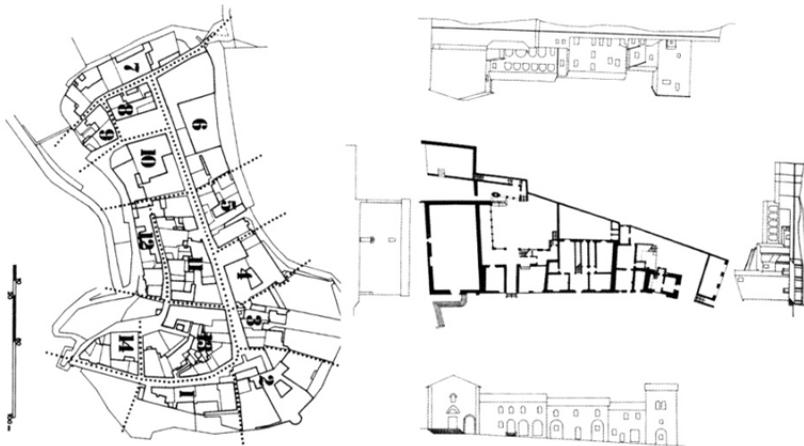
Rilievi dell'aggregato con pianta e prospetti
